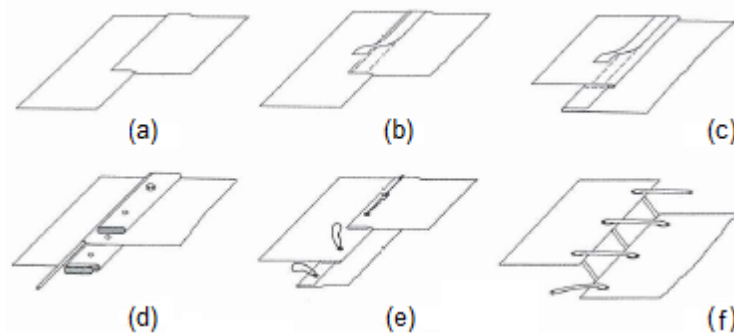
Tipos de ligações de superfície: a) junta soldada; b) junta costurada; c) junta costurada com aba; d) ligação em chapa metálica; e) ligação cordoadada; f) ligação entrelaçada [27]
